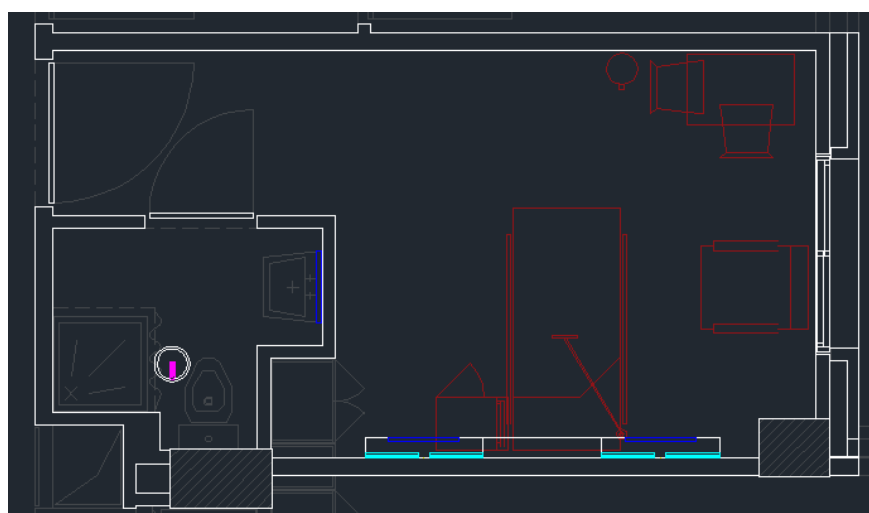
Planta Autocad da Enfermaria e Casa de Banho Privativa
